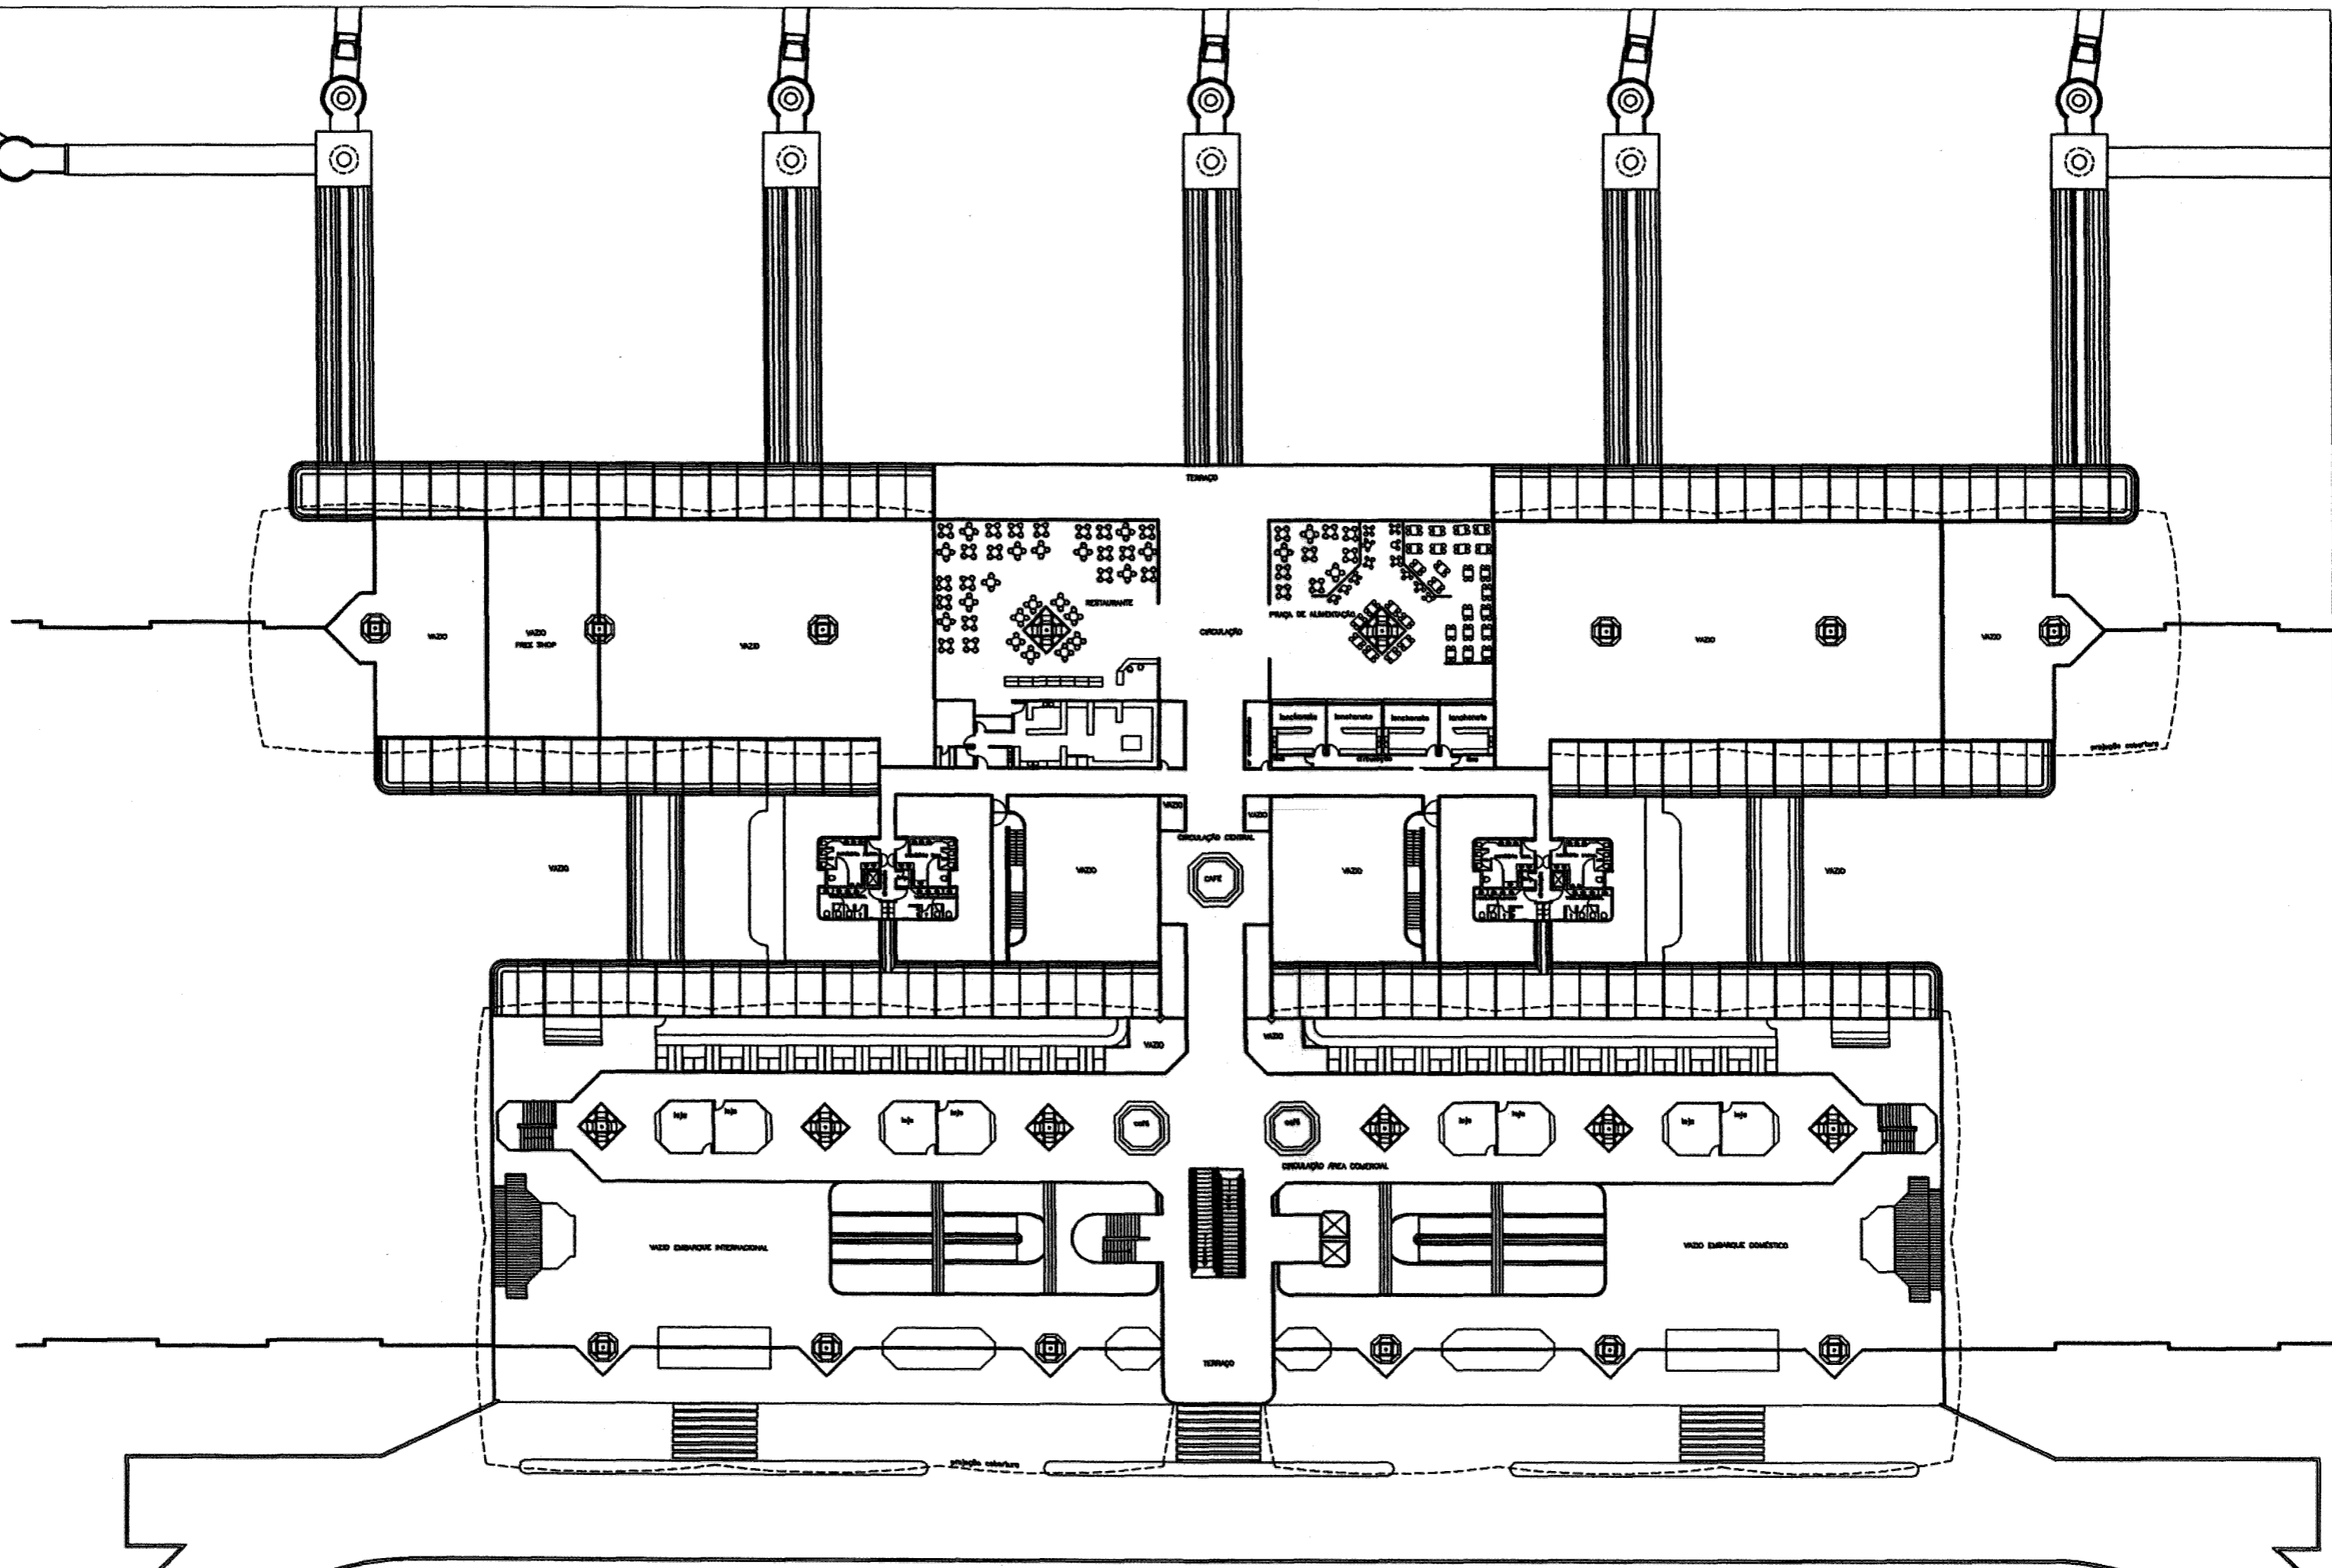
Planta Baixa Mezanino esc. 1:500.
